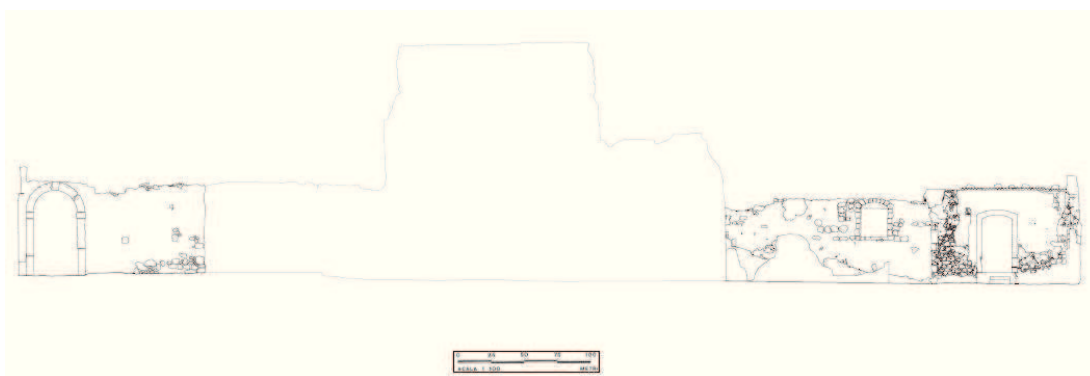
San Lorenzo Vecchio. Restituzione finale del prospetto interno alla corte, lato ovest, ricavata dall'integrazione di foto raddrizzamento e ortofoto 3D (restituzioni di Fabrizio Ragonese).
